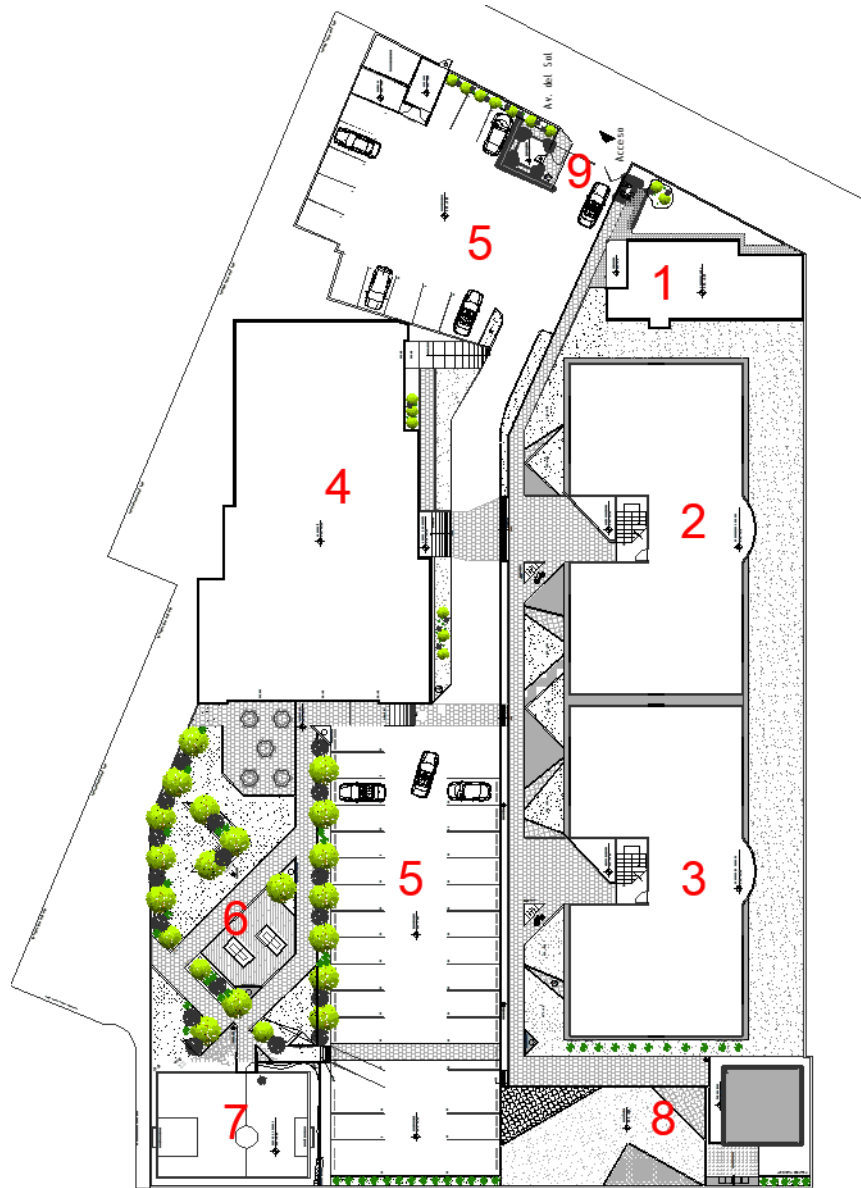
Planta de Conjunto de Villa Ibero.
